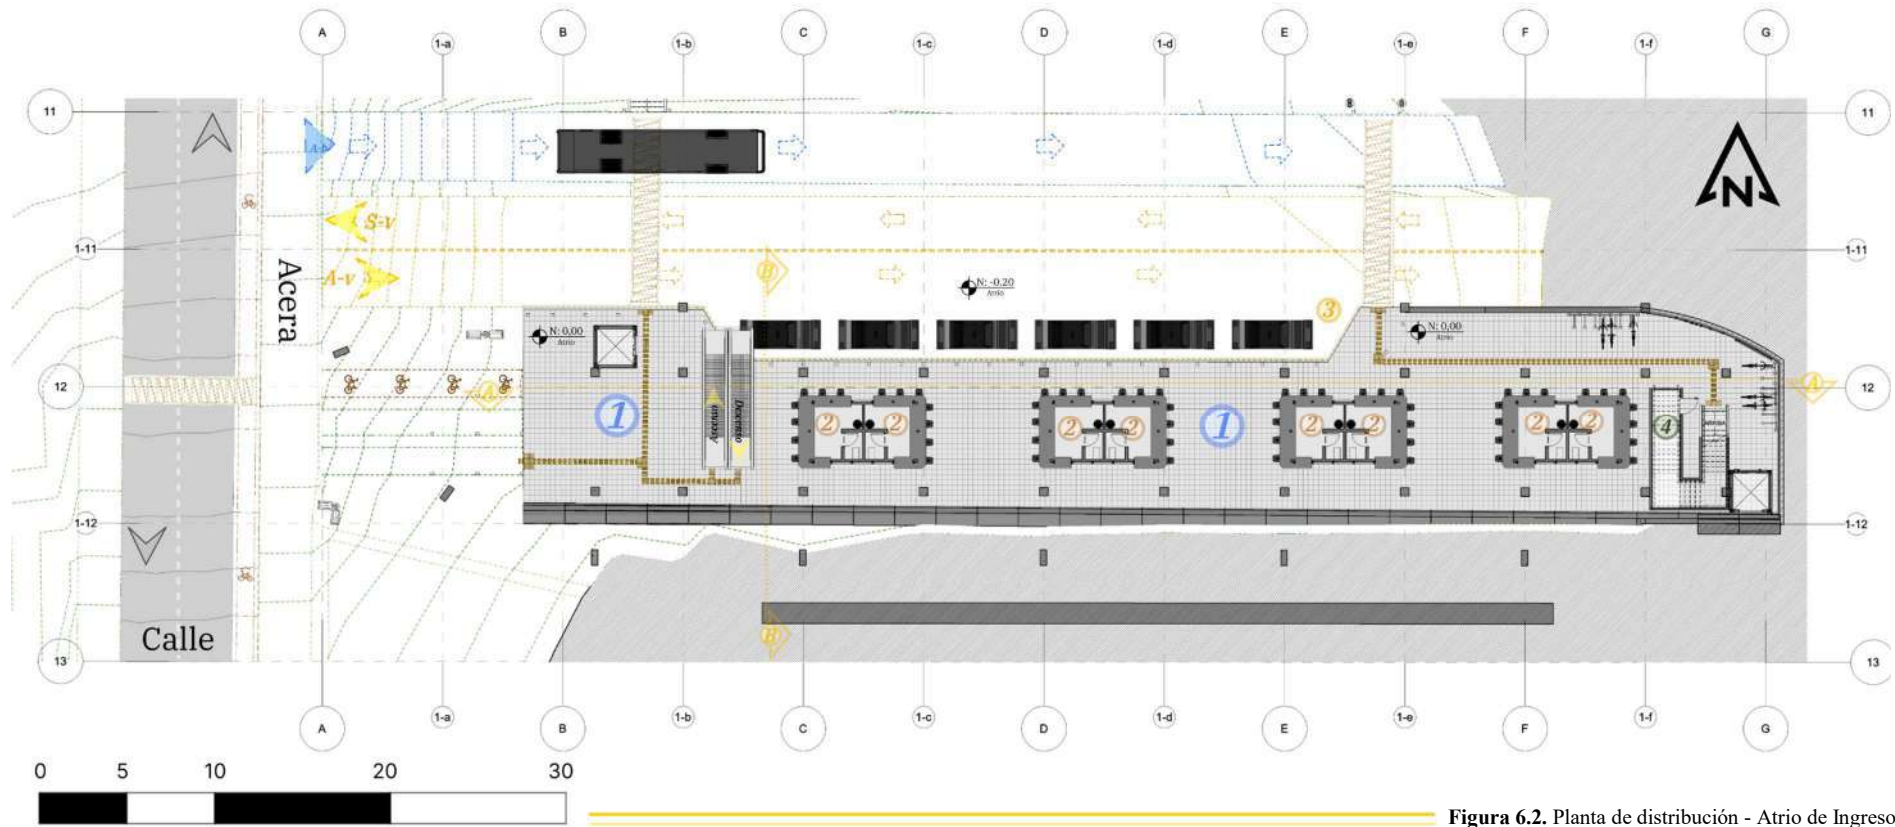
Planta de distribución - Atrio de Ingreso.
